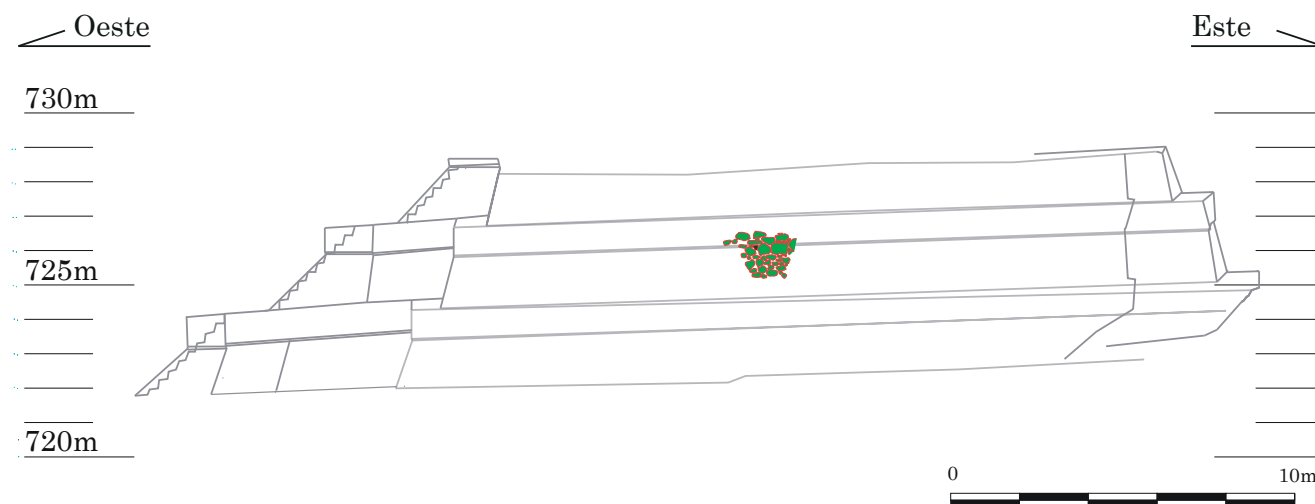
Lateral este-oeste de la estructura B1-2 y la ubicación del muro de la Fase I
